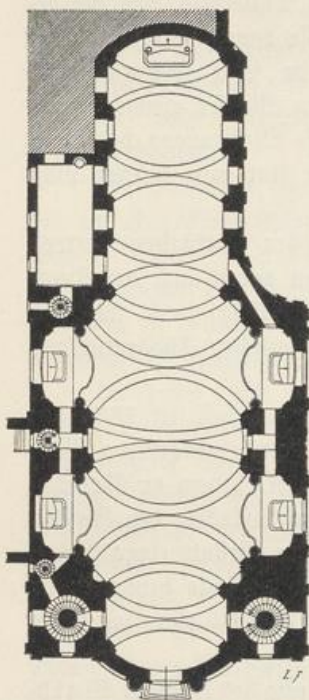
Grundriß der Kirche des Klosters Banz. (Nach Gurlitt.)
